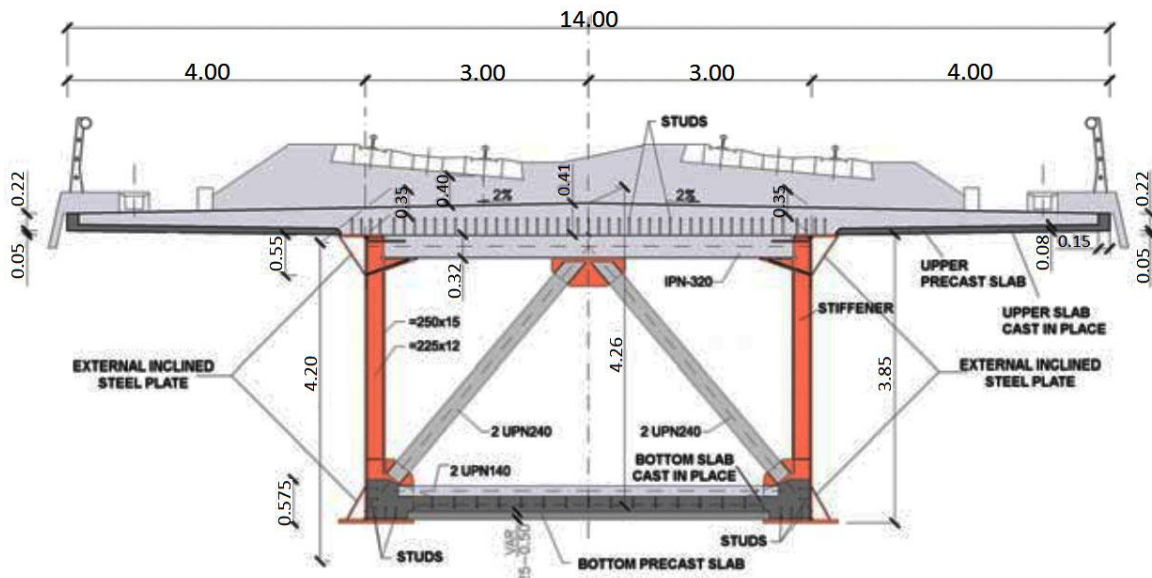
Seção transversal no apoio, viaduto “Arroyo las Piedras” (Millanes et al, 2009)
